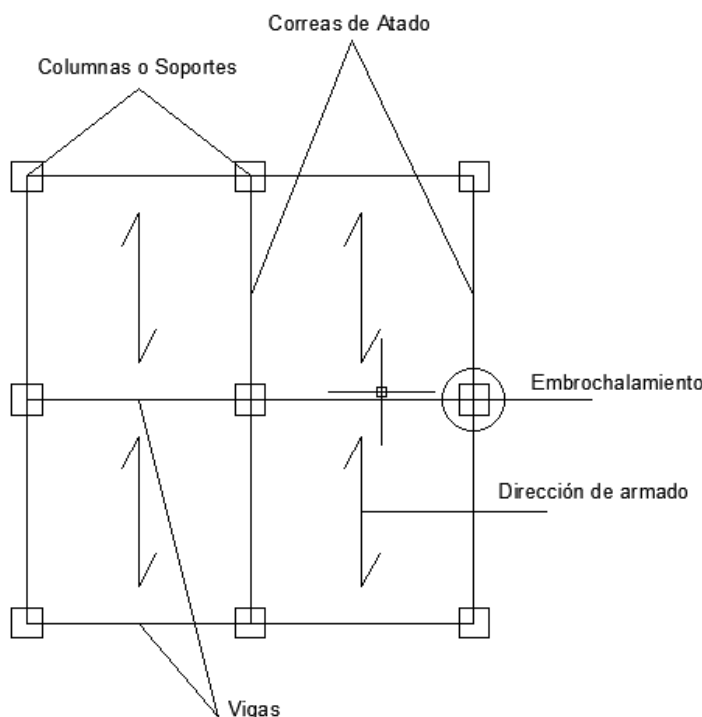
Disposición de componentes en cubiertas (Correa, 2003)
